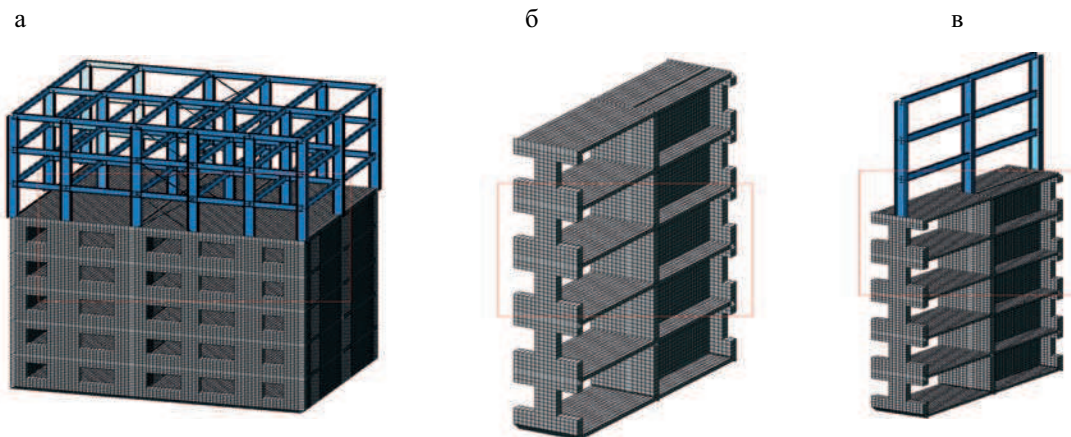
Расчетные схемы реконструируемого здания: а - пространственная расчетная модель здания; б - исследуемый фрагмент реконструируемого здания; в - исследуемый фрагмент здания с надстройкой
